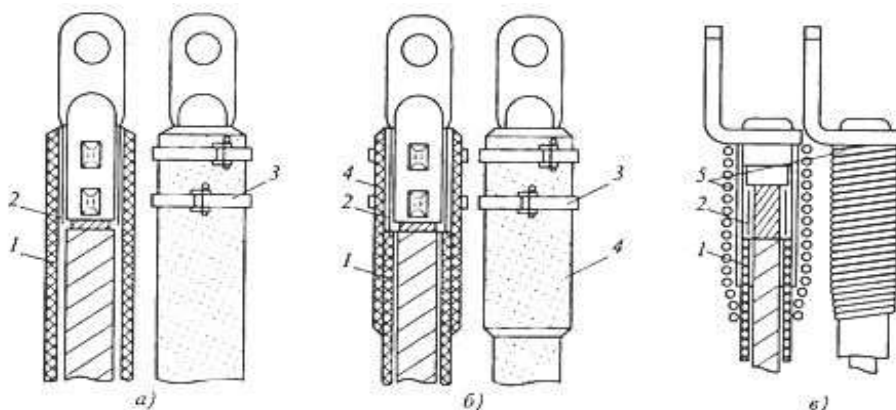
Способы уплотнения резиновых трубок на алюминиевом наконечнике: а — с предварительным отворачиванием трубки, б — с помощью отрезка трубки, в — крученым шпагатом на литом наконечнике, 1 — резиновая трубка, 2 — подмотка лентой из маслостойкой резины, 3, 5 — бандаж из стальной полоски и шпагата, 4 — муфточки из резиновой трубки
